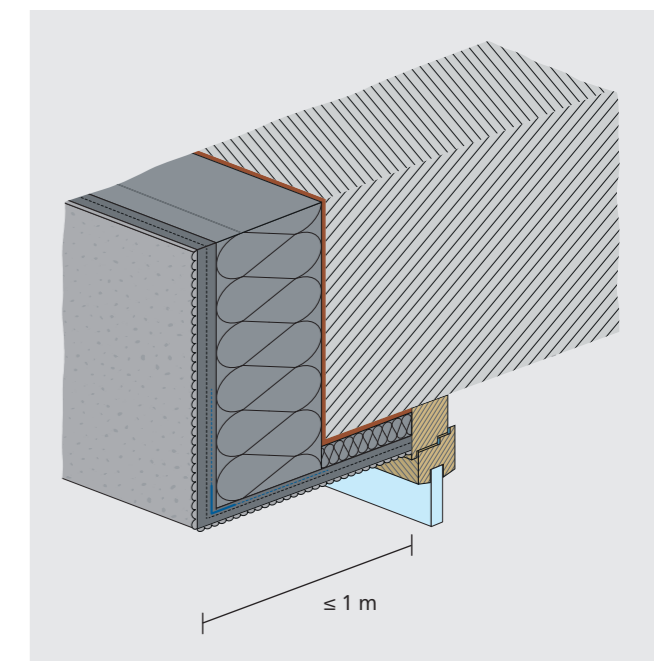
Fassadenrücksprung mit horizontaler Dämmung
